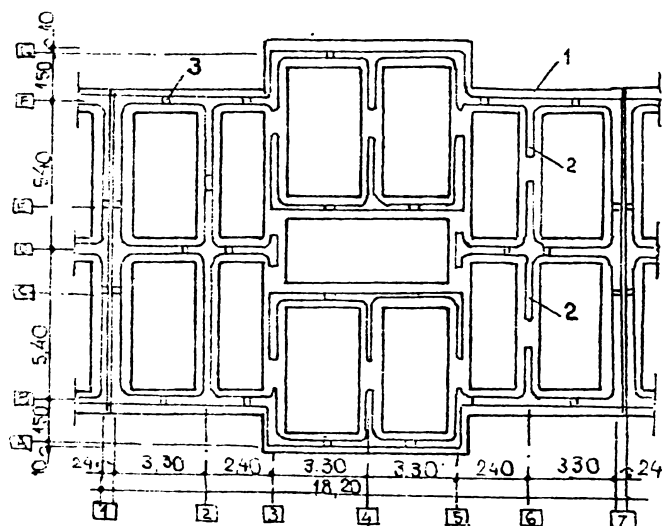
Planul de montaj al elevațiilor spațiale: 1-talpă monolită; 2-elemente spațiale pentru elevații; 3-mono-litizare.
